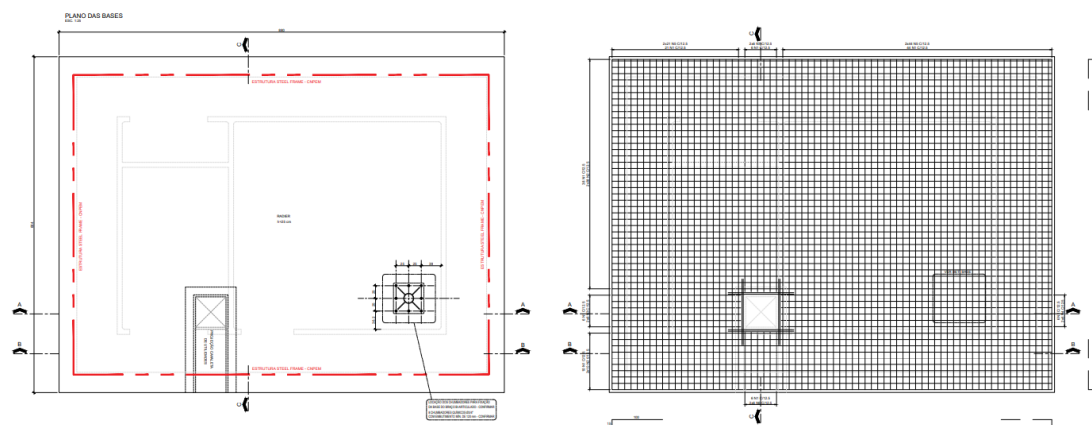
Projeto estrutural da base de fundação do laboratório Cryoloading.
